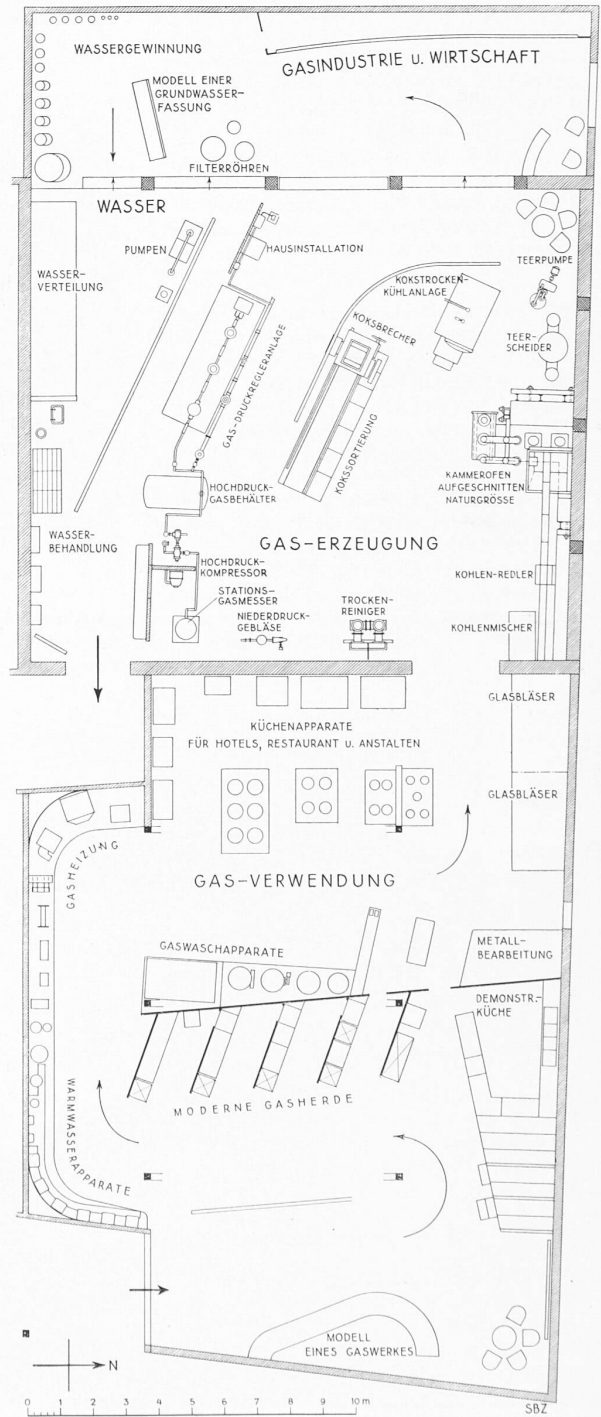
Gas und Wasser in der Abteilung Bauen. — Grundriss 1 : 210
